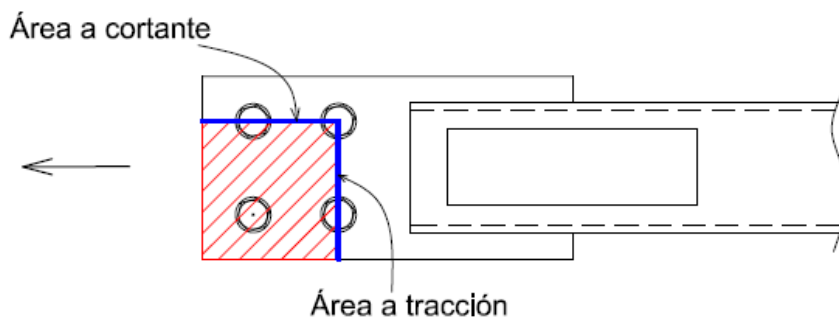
Bloque de corte en plancha PL1-forma en 1L
